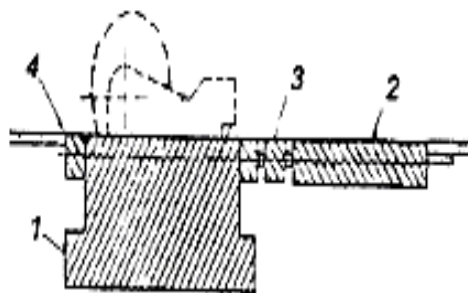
Схема влаштування плитогасителя горизонтальних коливань компресора: 1 – фундамент; 2 – плита-гаситель; 3 – проміжна ланка; 4 – прокладки
